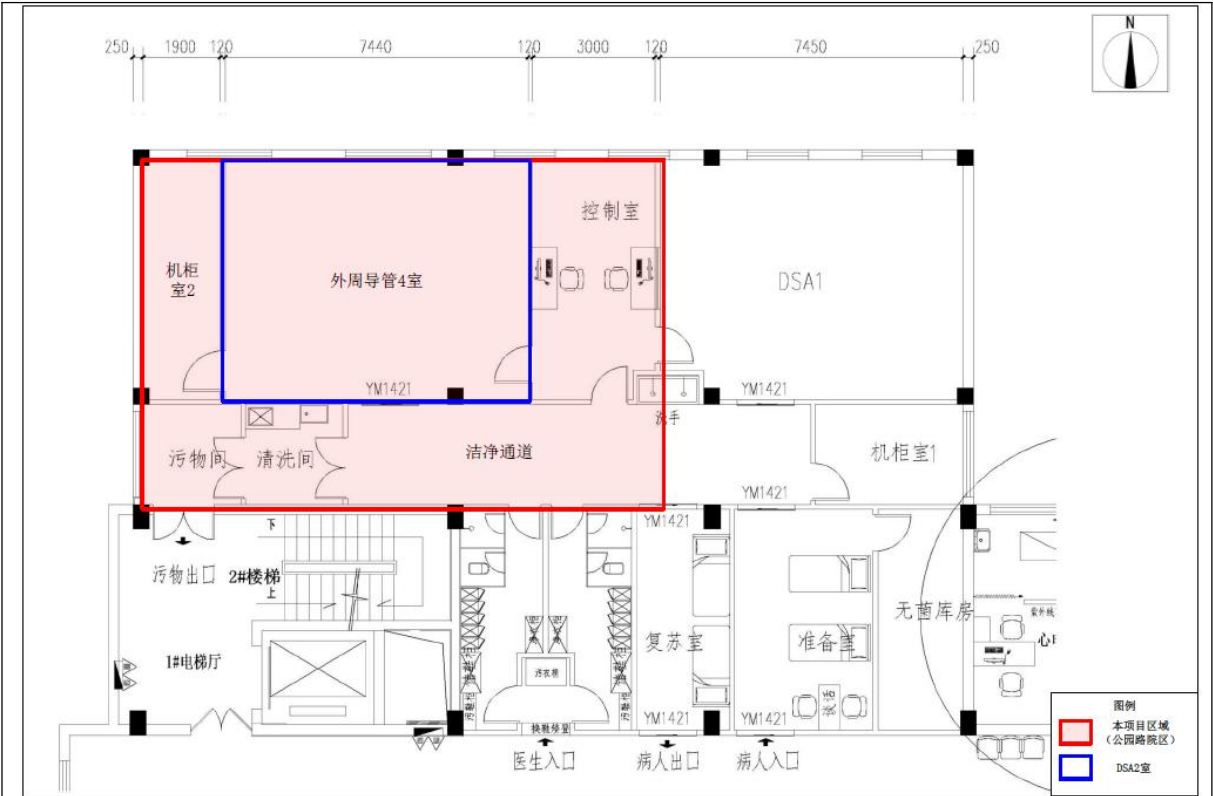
本项目公园路院区门诊楼二层外周导管 4 室平面布置图
